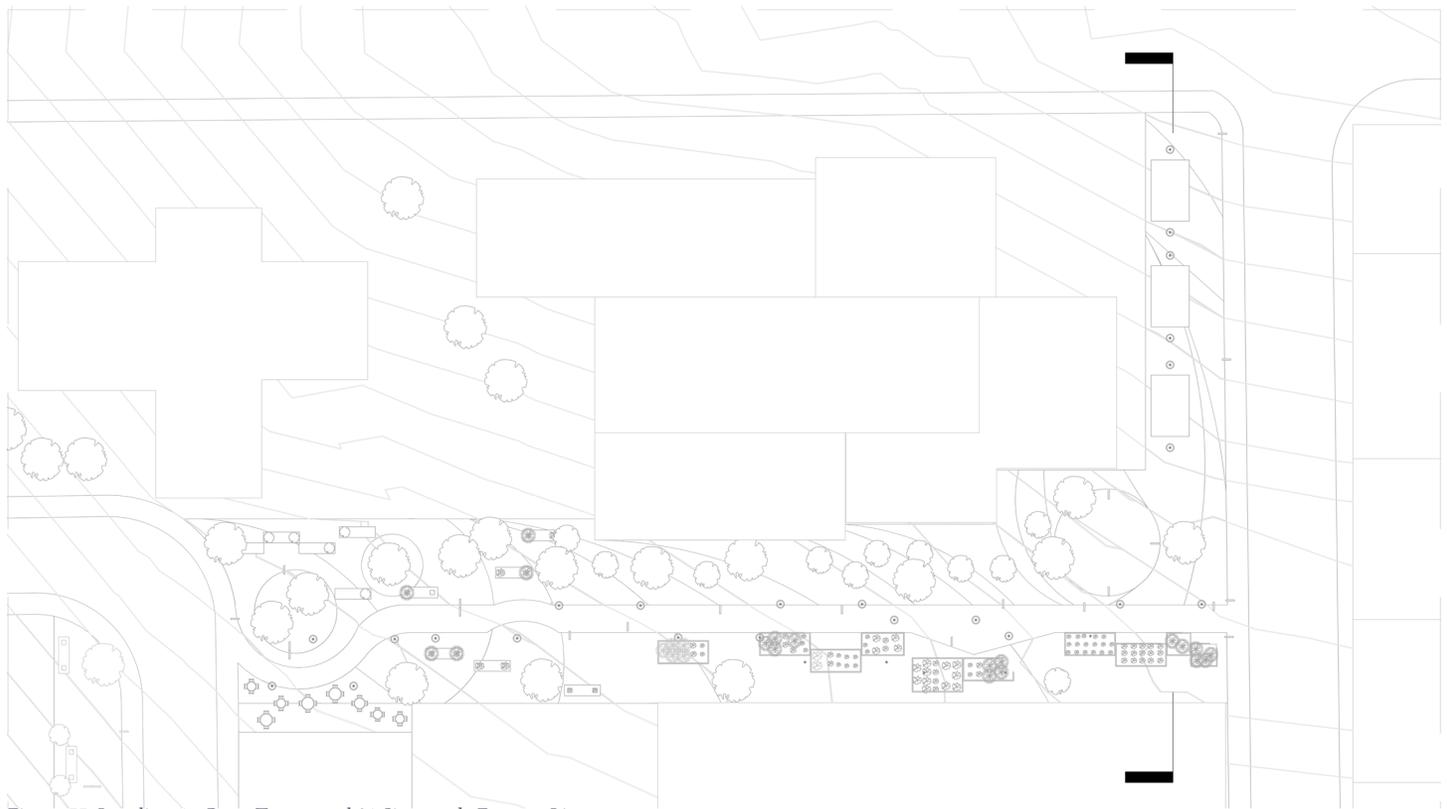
Localização Corte Transversal 01 Sistema de Espaços Livres
